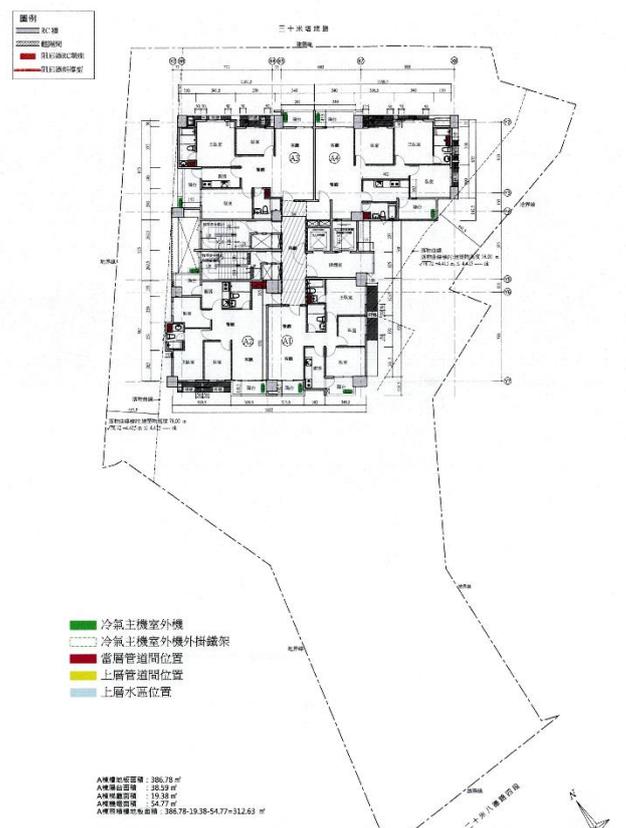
十九~二十一層平面圖 (S : 1/300)
